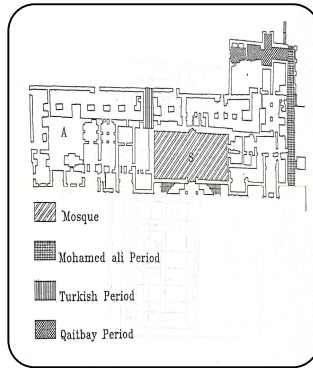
مسقط أفقي للدور الأول لمصنع الكسوة
